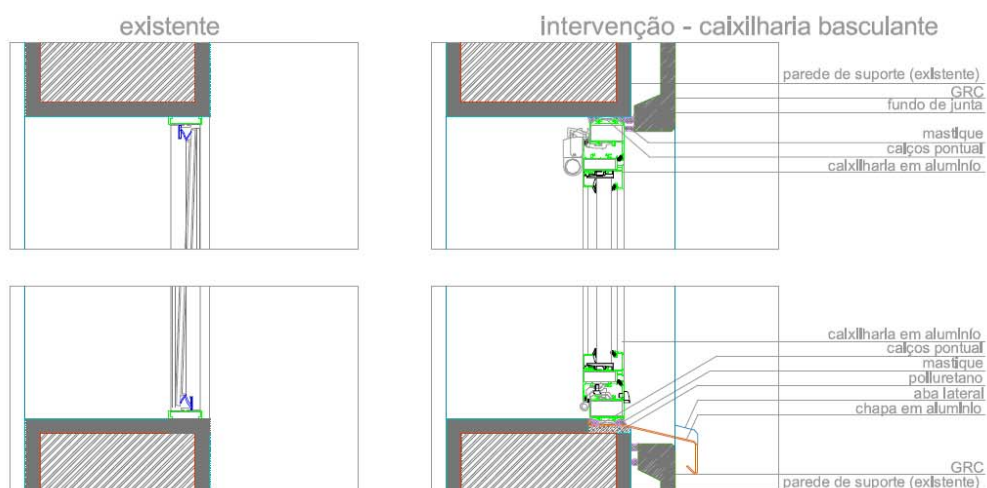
Novo caixilho basculante da caixa de escadas. Pormenor construtivo vertical (escala 1/10).
